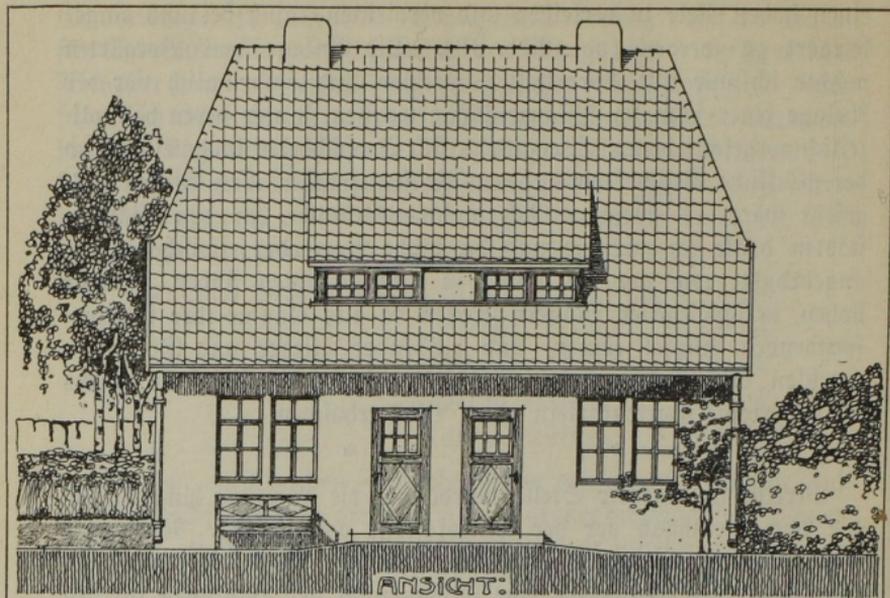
Wagner, Loh und Schacht in Bremen. Zweifamilienhaus in Einwarden.
